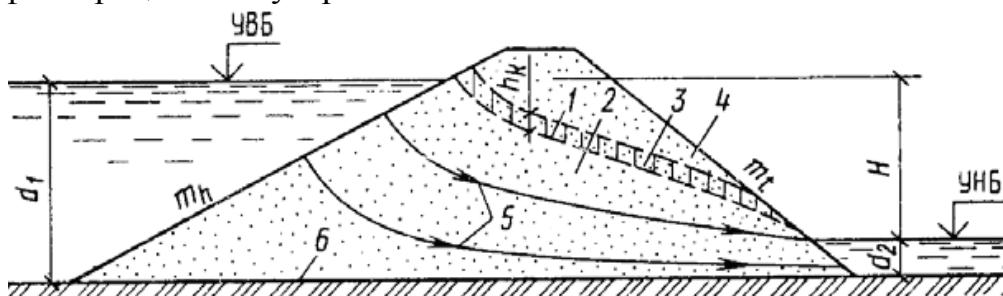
Схема фильтрации воды через земляную плотину на водонепроницаемом основании: 1 – кривая депрессии; 2 – зона полного насыщения грунта водой; 3 – зона частичного насыщения грунта водой (капиллярный подъем); 4 – сухой грунт; 5 – линии токов; 6 – водоупор; h_k – высота капиллярного подъема; H – напор
